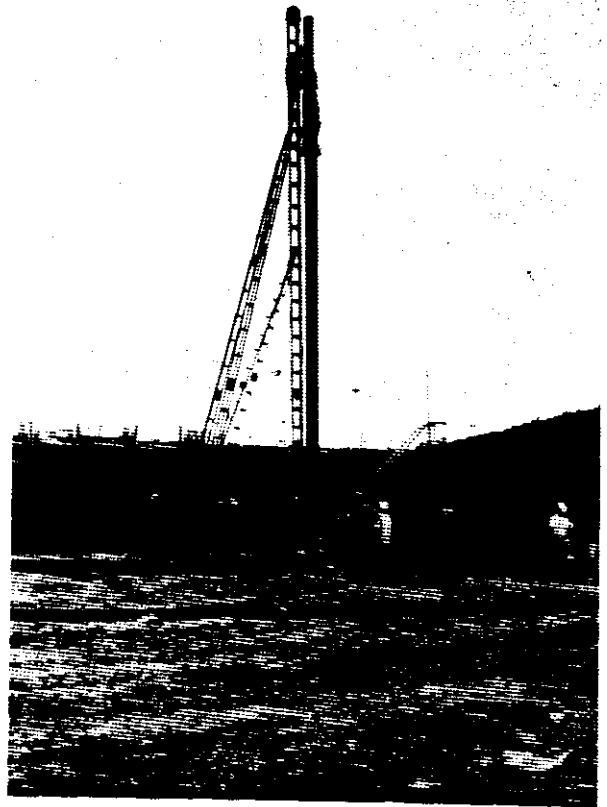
Cravação de perfis utilizando bate-estaca DELMAG.
